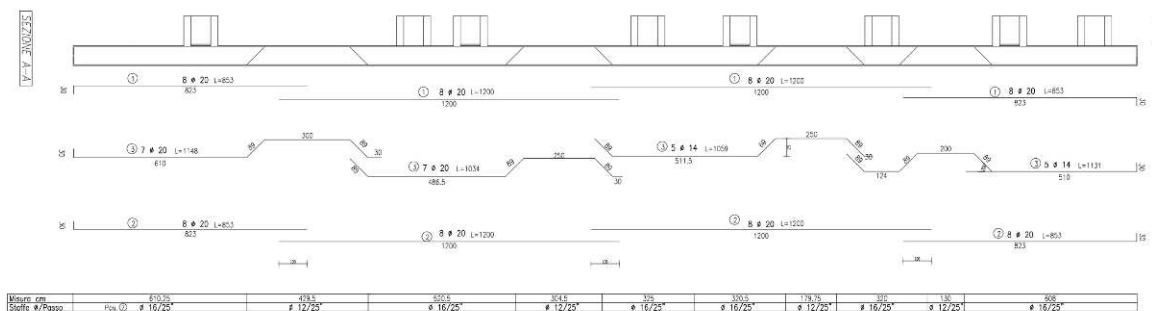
Trave di collegamento in fondazione per edifici industriali
